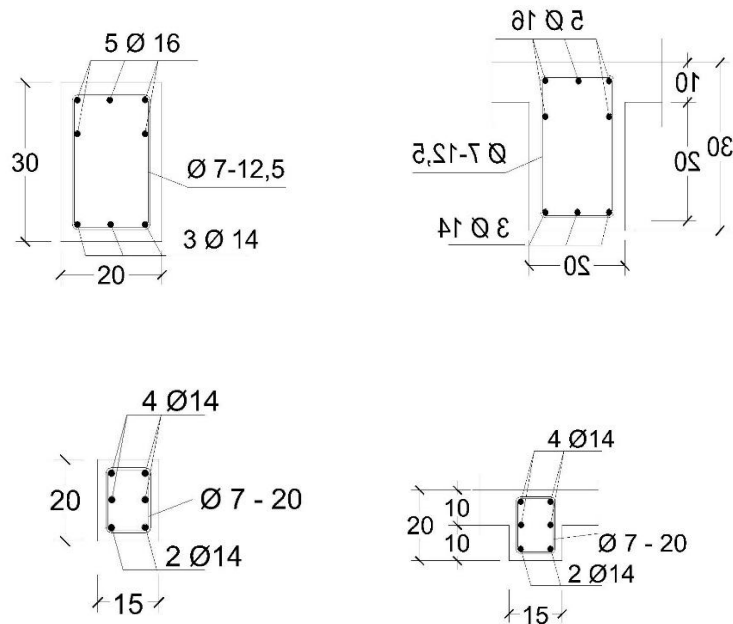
Denah Balok Lantai 1 Sampai 5
